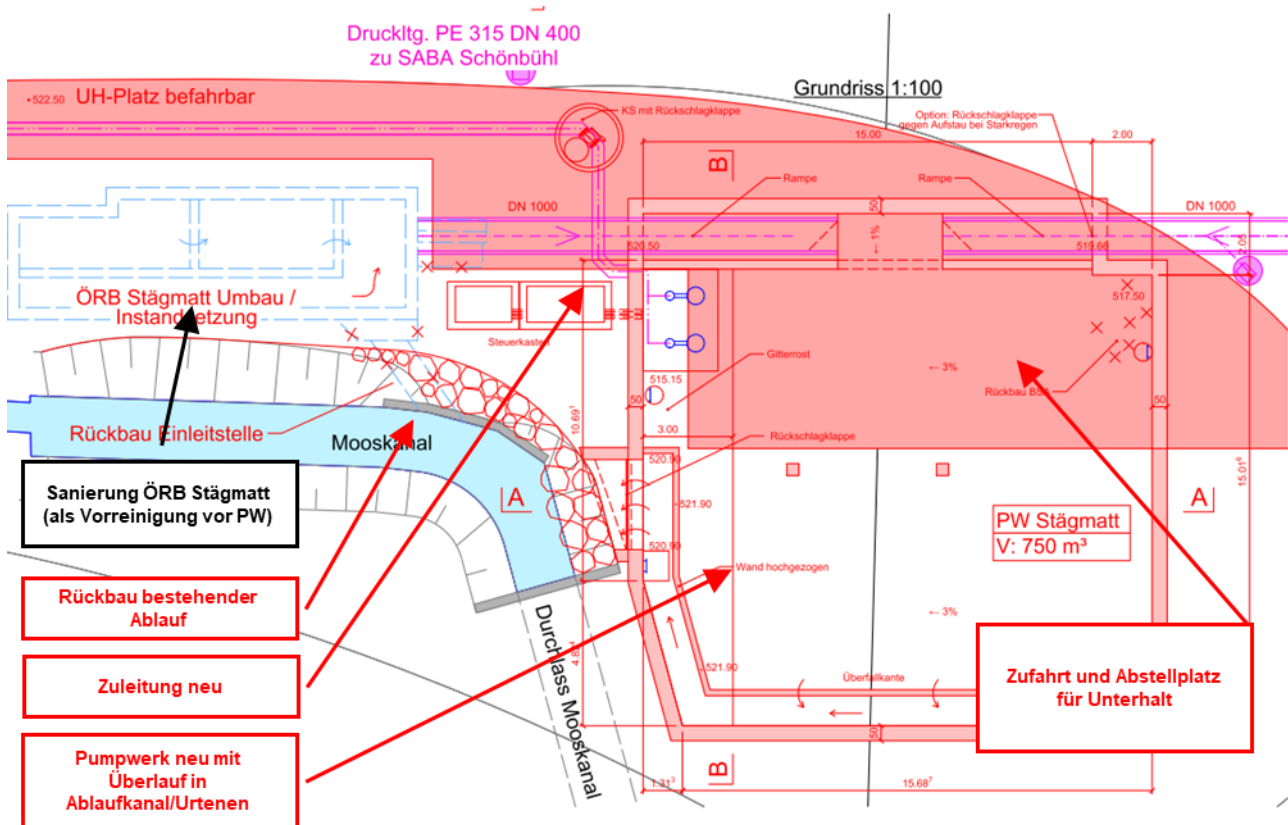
Pumpbecken Stägmatt neu – Grundriss
